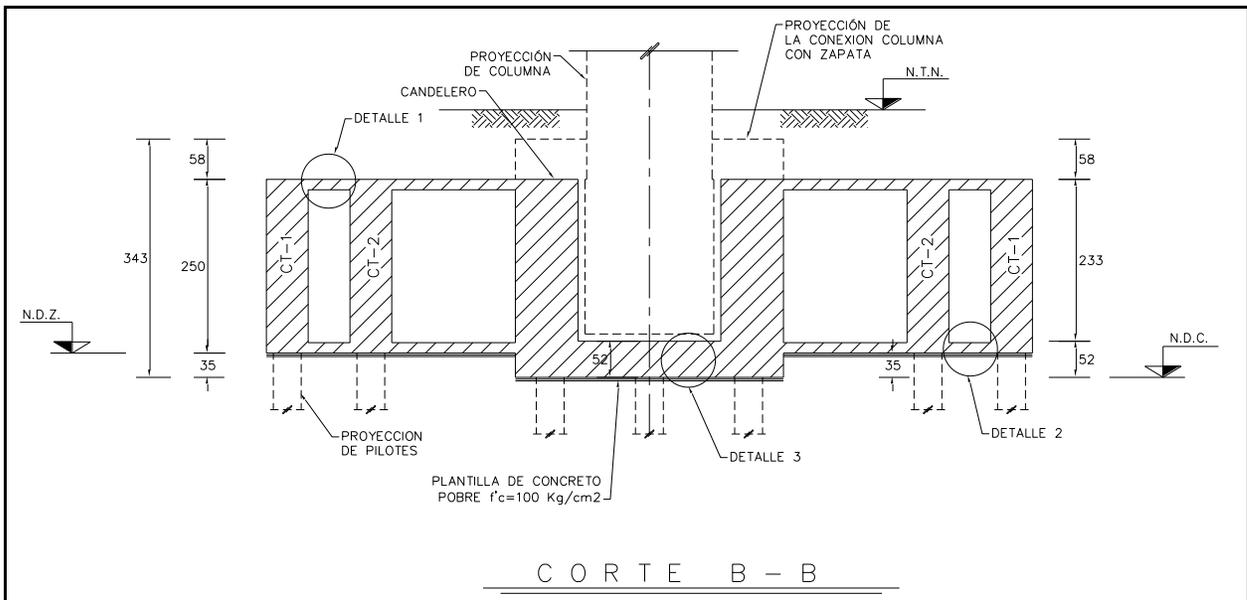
Corte B – B de zapata cuyos ejes de columna son A10 – A11. Todas las acotaciones están en cm, excepto donde se indique otra unidad. Niveles en metros.
